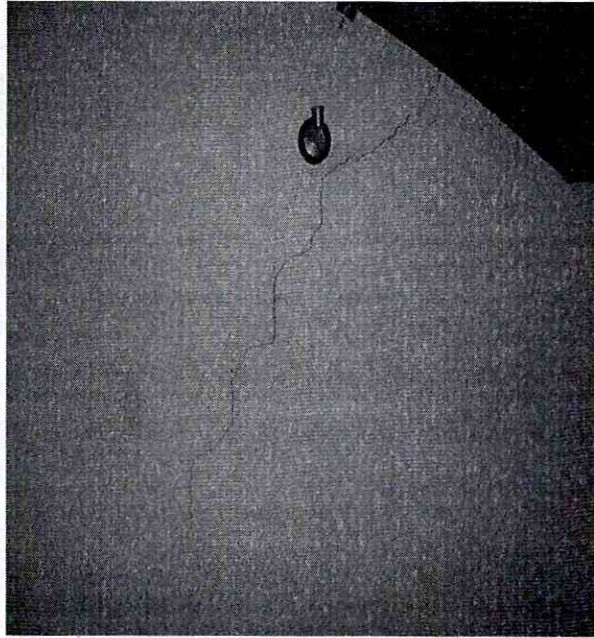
Al interior de la vivienda se pueden observar fisuras y grietas de hasta 10 milímetros de abertura.
